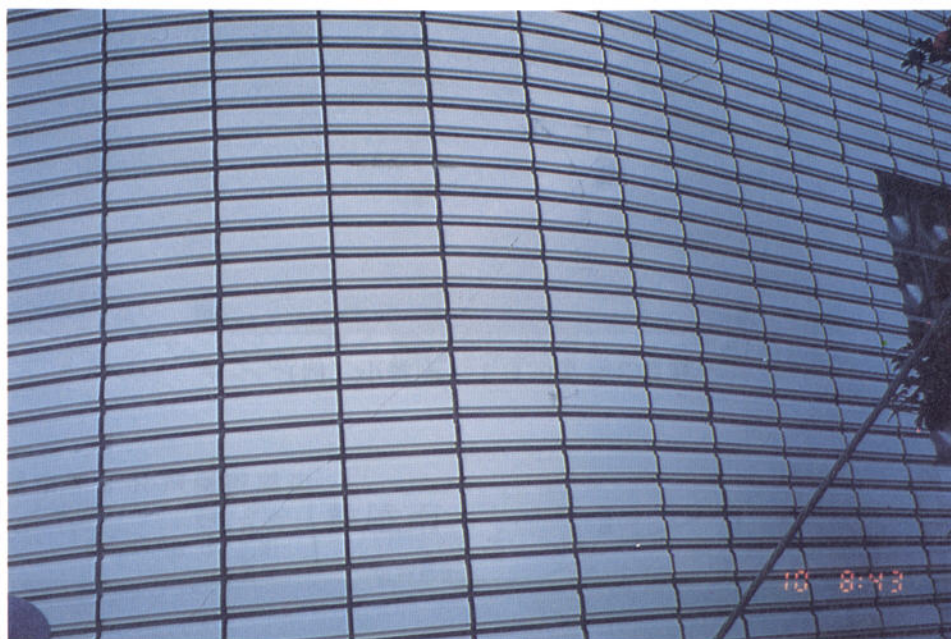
5. B 1 : ひび割れ小 (例)
